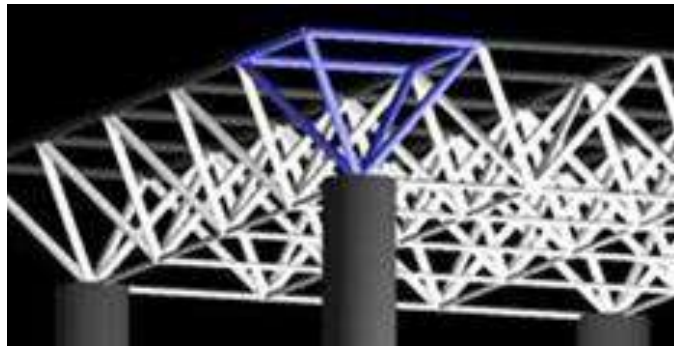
Contoh Aplikasi Struktur Space Frame Pada Bangunan
